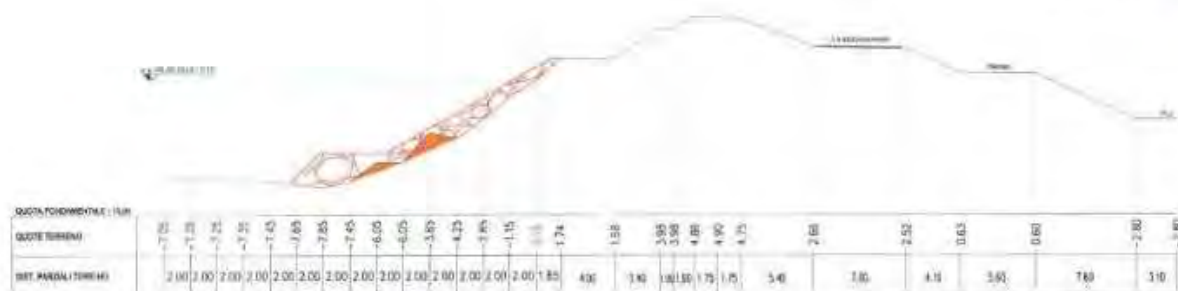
Esempio 3: sezione tipo difesa spondale Po.
